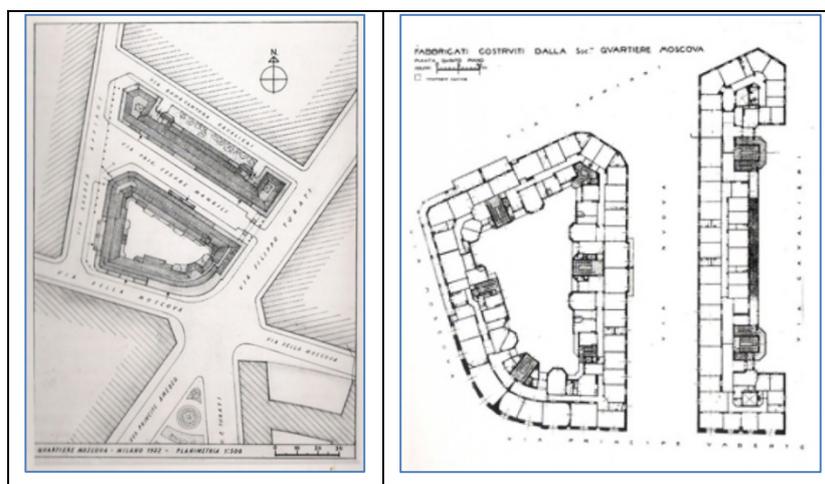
Planimetria generale dell'isolato e Piante del quinto piano.
